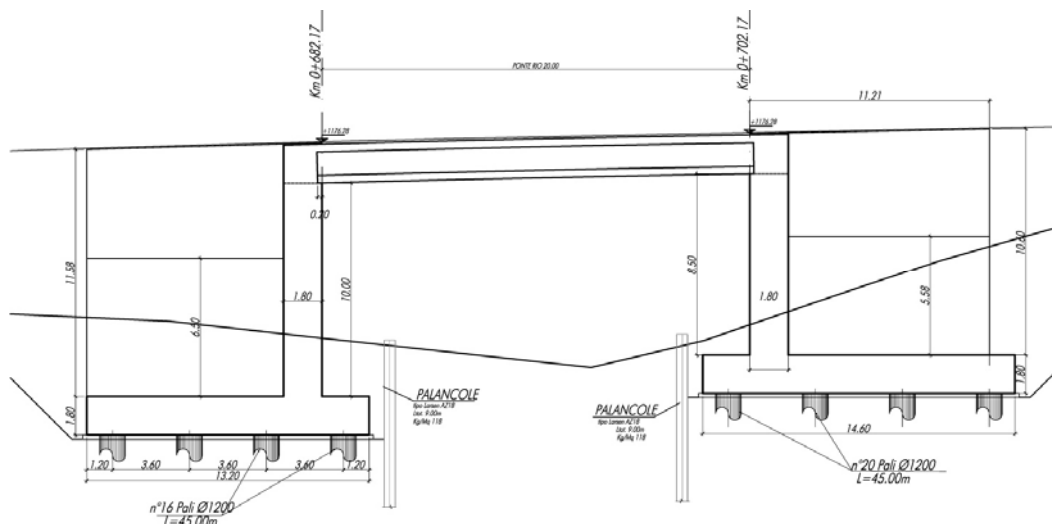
Sezione Longitudinale del Ponte Ries (ns. elaborazione da tavola T01VI03STRDIO1_A_Pianta impalcato, sezione longitudinale e dettagli del progetto definitivo).
